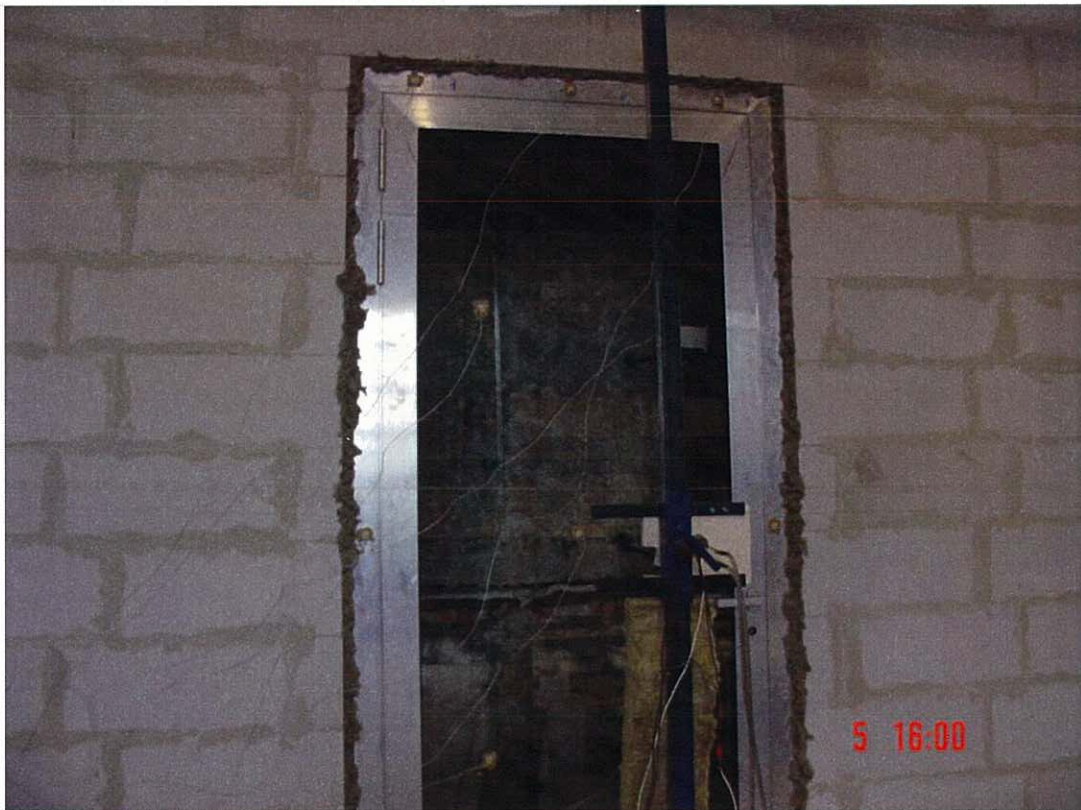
aanzicht van de constructie voor aanvang van de brandproef
